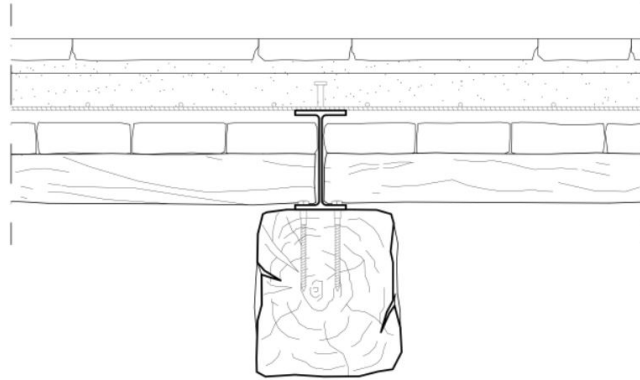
Consolidamento del solaio ligneo con IPE in acciaio.
